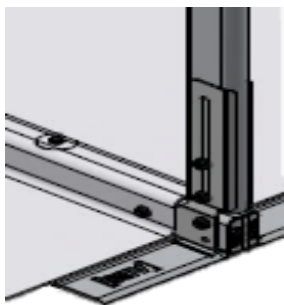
Montant avec plaque adaptatrice montage du toit vert
